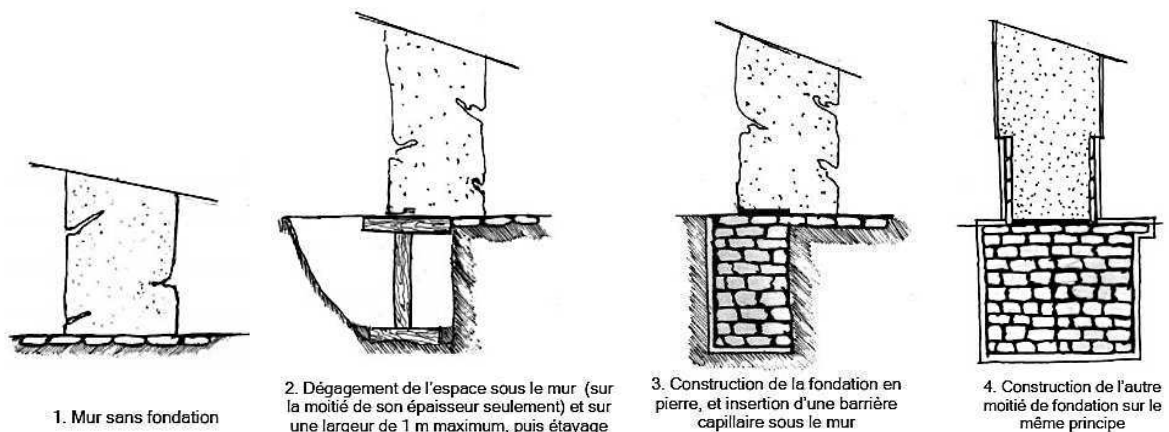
Schéma de l'insertion d'une fondation en pierre [26]
